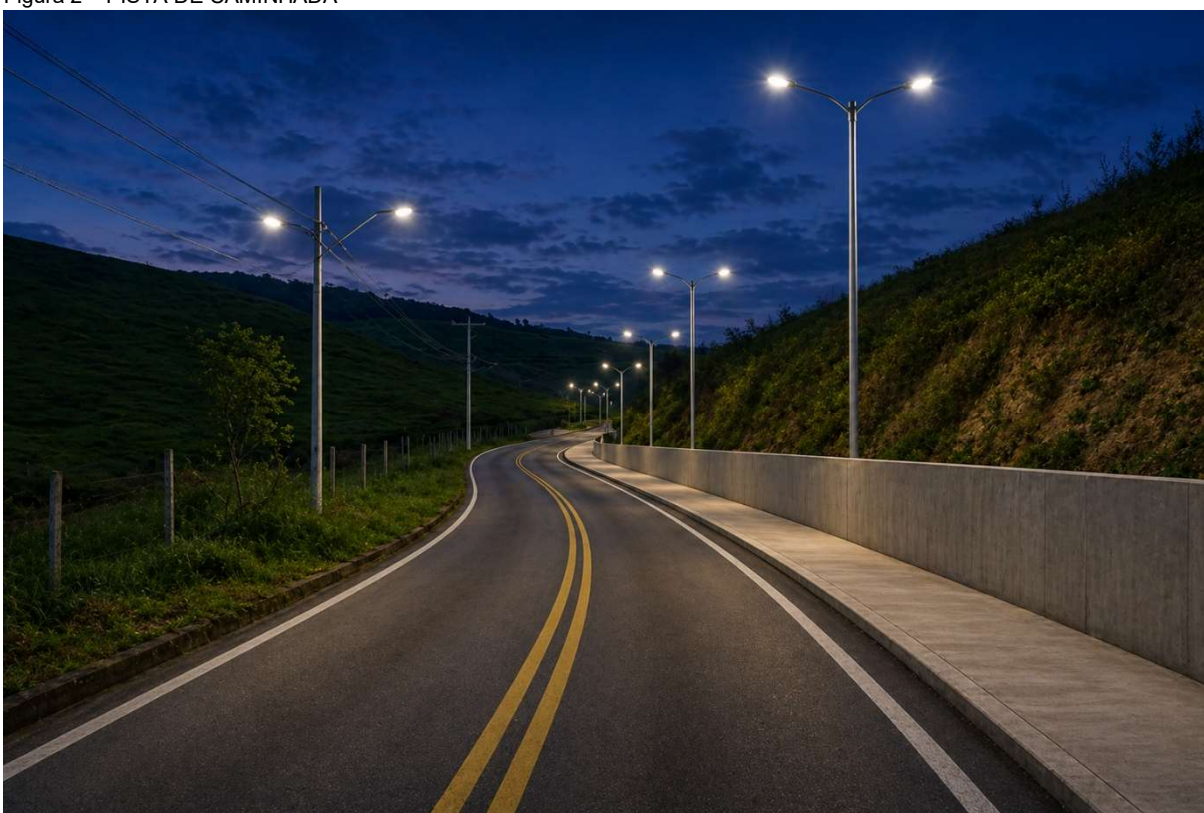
PISTA DE CAMINHADA E MURO DE PROTEÇÃO PARA PEDESTRES NOTURNO
